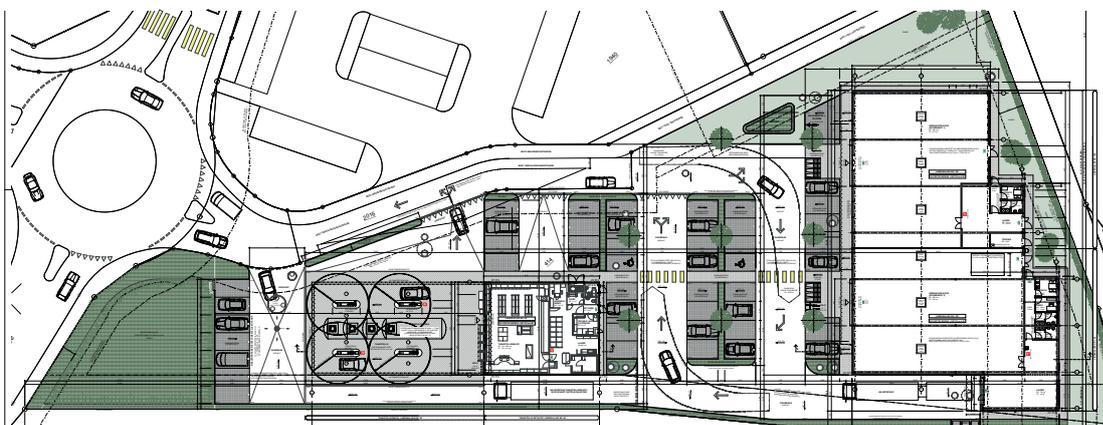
Situationsplan Baugesuch 2013 mit Tankstelle links und Verkaufsgebäude rechts
